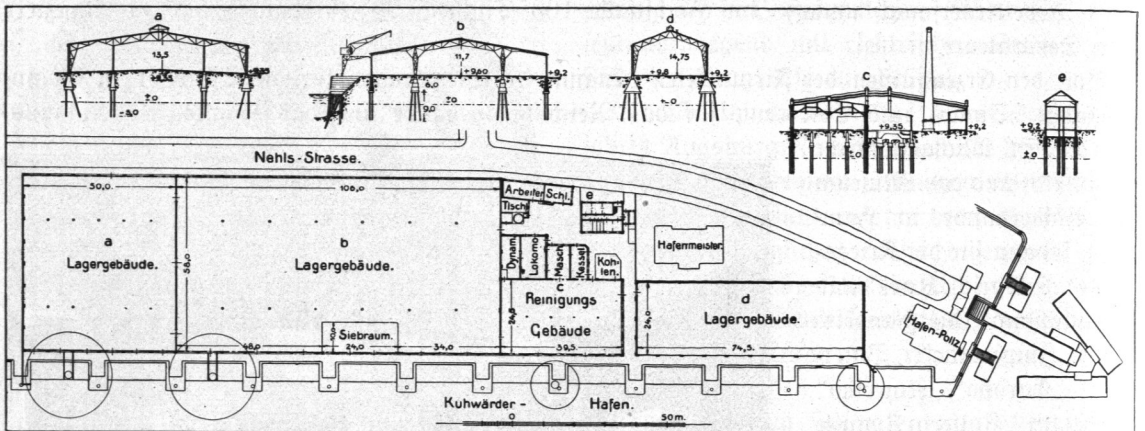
bis 956. Hamburger Reiserwerke m. b. H., Lageplan und Querschnitte.
